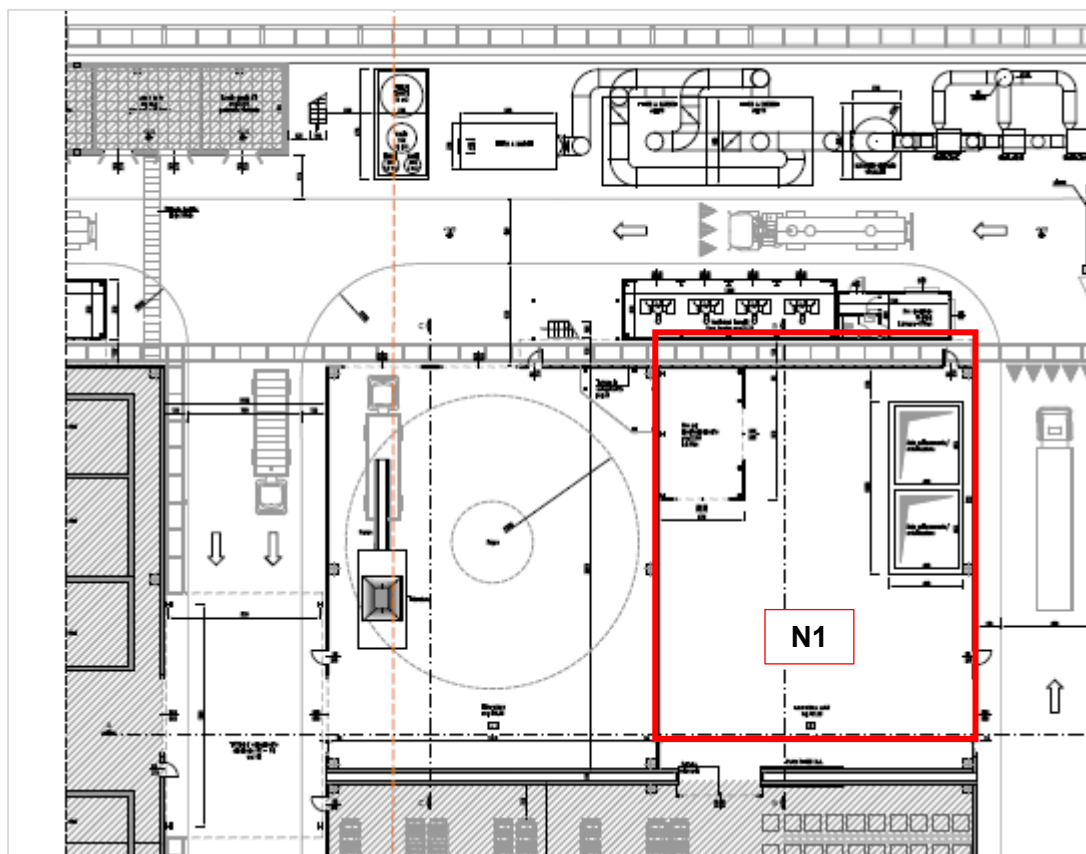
Dettaglio localizzazione Sezione N1 (stralcio elaborato CO 05 RA VA 01 D1 PL 58.00 - N1-N2 PIANTE)
